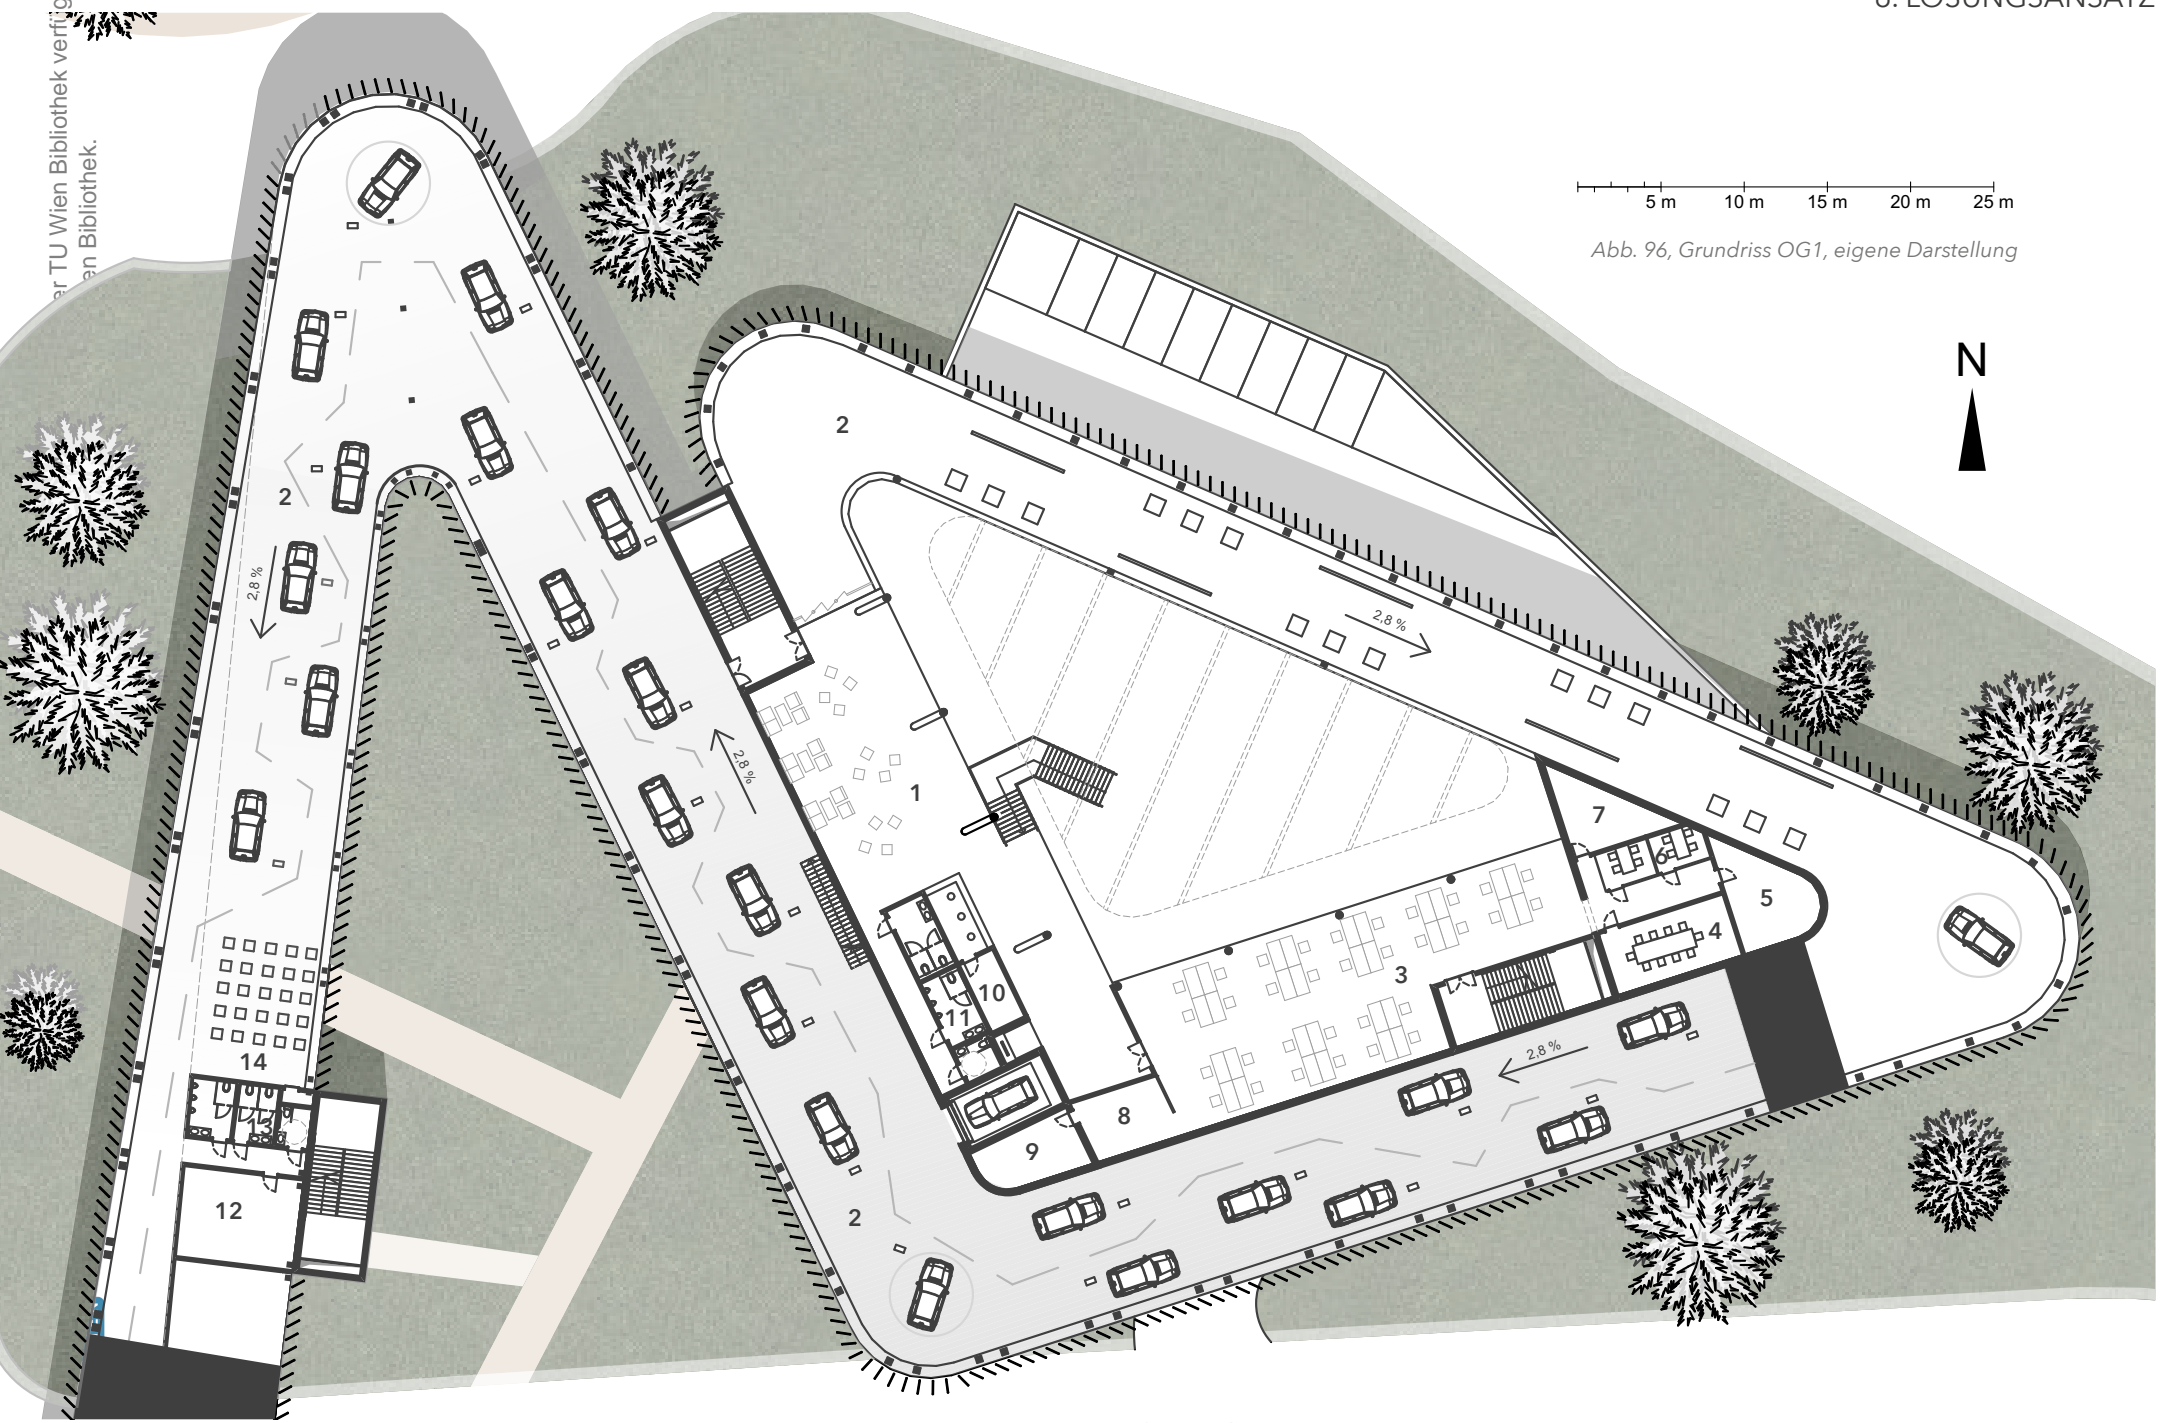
, Grundriss OG1, eigene Darstellung
